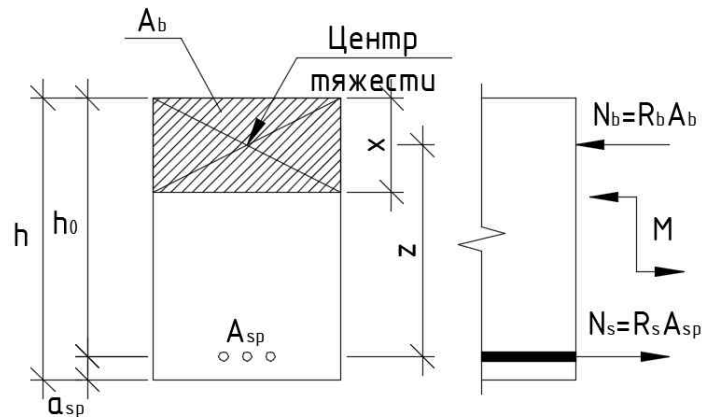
Геометрические параметры нормального сечения изгибаемой железобетонной конструкции и схема усилий в этом сечении
